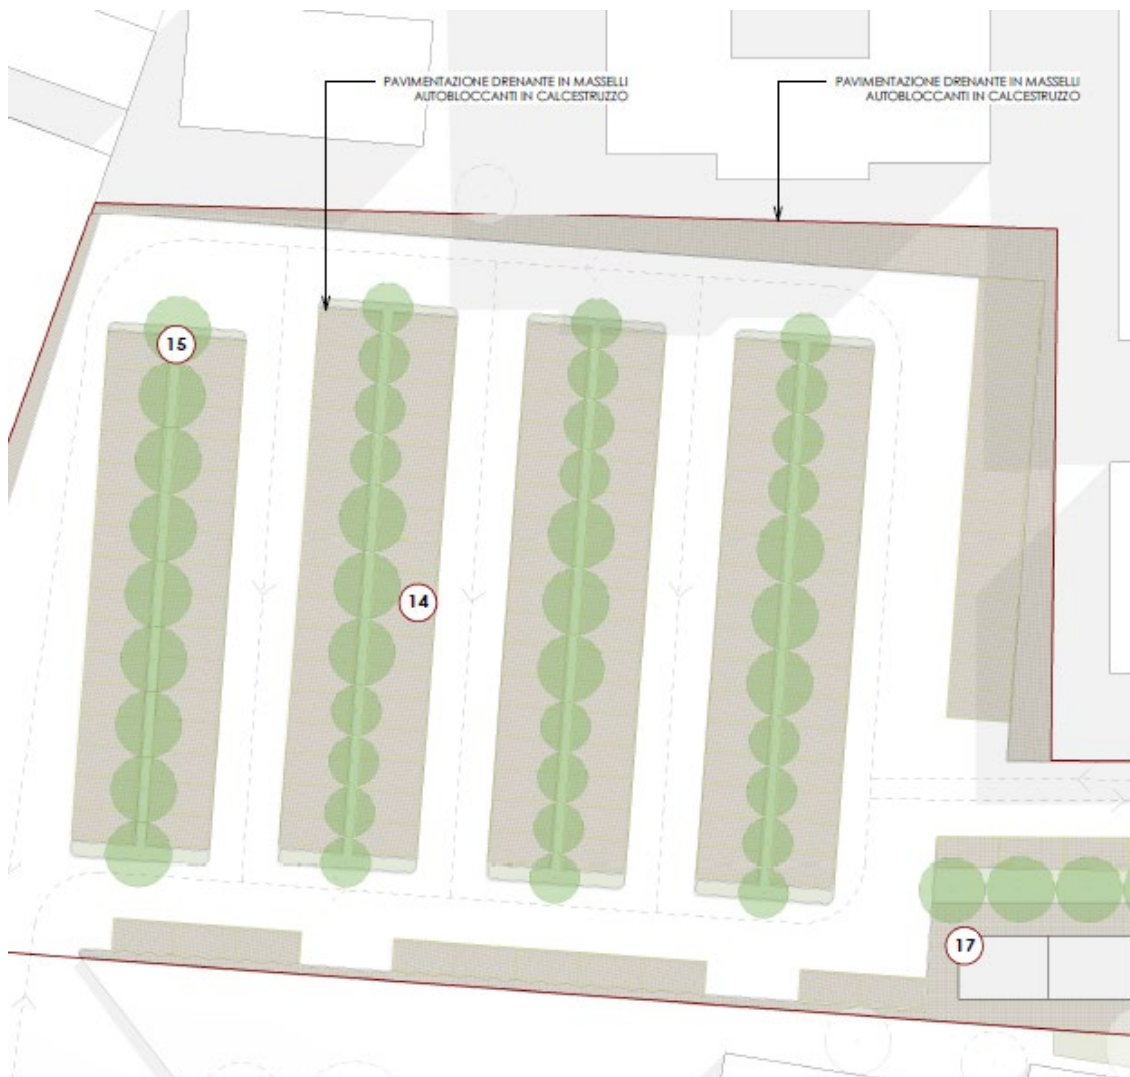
Planimetria delle sistemazioni esterne (area parcheggio)
